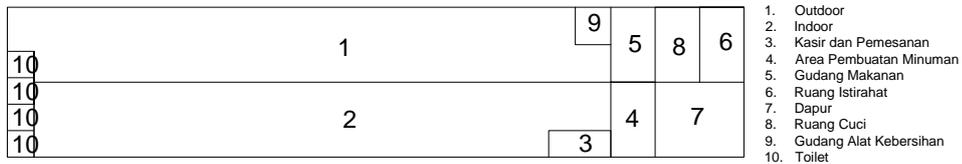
Blok Plan Gedung Apresiasi Lantai 3 (sumber: analisis pribadi, 2020)
